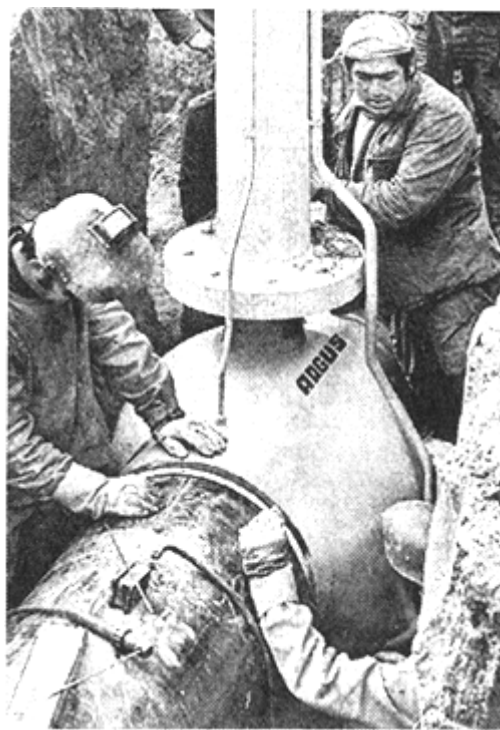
Монтаж шарового крана на магистральном газопроводе
